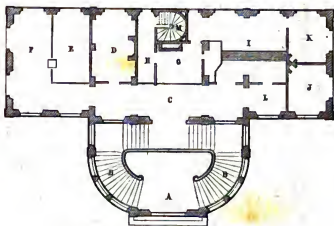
Station de Chelles. Rez-de-chaussée.
